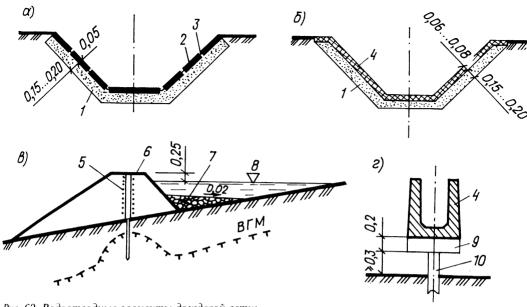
Водоотводные элементы дождевой сети: a, 6—лотки, врезанные в грунт; в— валы-канавы; г—лоток на сваях; 1— теплоизоляционный материал; 2—одежда из сборных армоцементных или железобетонных плит; 3— заделка швов эластичным герметиком; 4—сборные фасонные железобетонные блоки; 5—упорная плетневая стенка; 6—одерновка; 7— крупный гравий по мху; 8—расчетный уровень воды; 9— насадка; 10—свая
